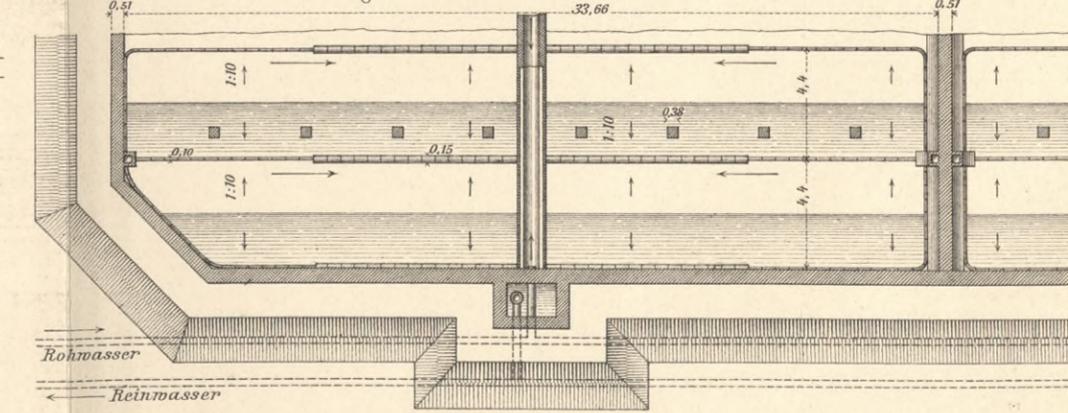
<sup>c</sup> Grundriss von Filter IV. M.1:300.
